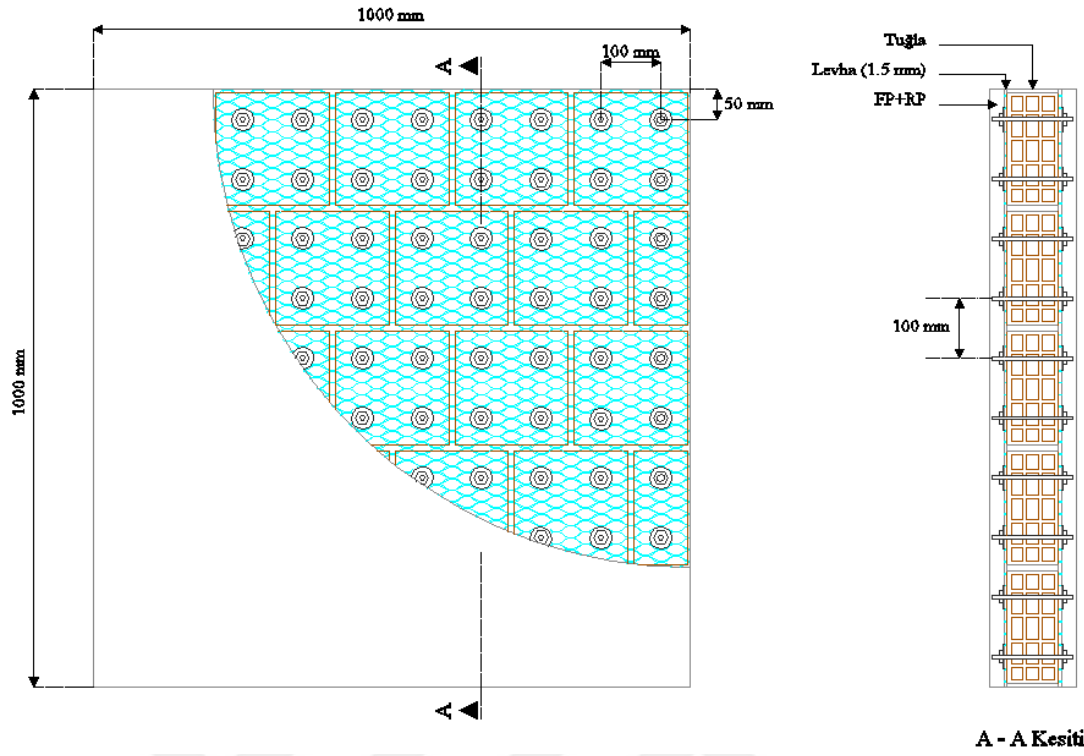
B1,5-500 deney elemanının boyutları ve güçlendirme detayları
